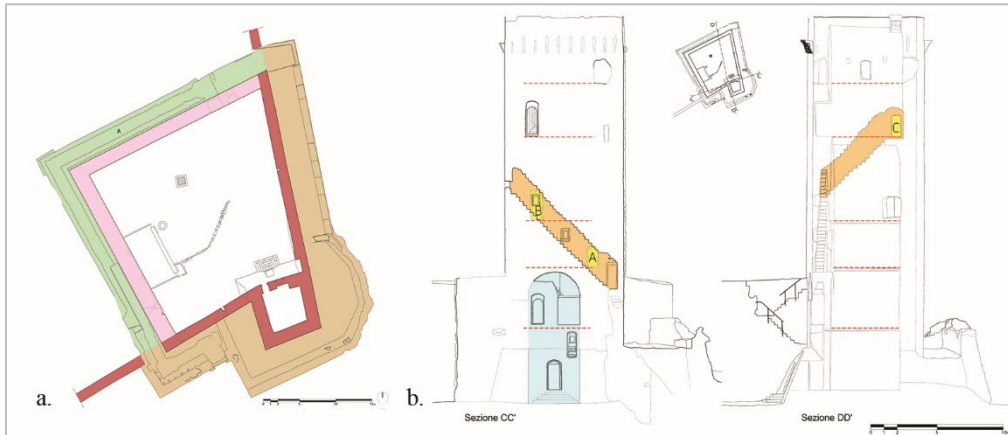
a. Assisi, nella pianta della Rocca Minore si indicano: le mura e la torre (in rosso); le pareti aggiunte che delineano il cortile (rosa); l'antemurale esterno (marrone) e quello interno (verde); b. Assisi, sezioni delle pareti nord-ovest e sud-ovest; sono evidenziati la scala in galleria (in arancio), gli accessi a tre livelli della torre (A, B, C); il fornice alla base della torre (ciano) e i livelli dei solai (tratteggio rosso) (elaborazione grafica di Sophia Naomi Zarro, 2024).
